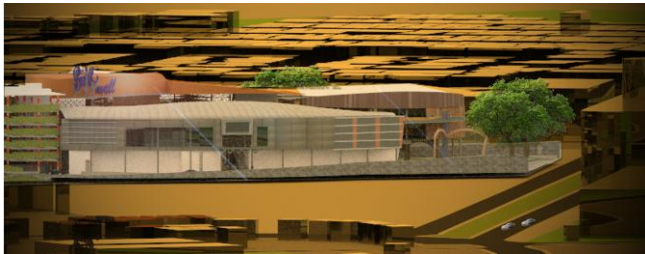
Tampak Bangunan Dari Arah Timur Laut. Sumber: penulis.
